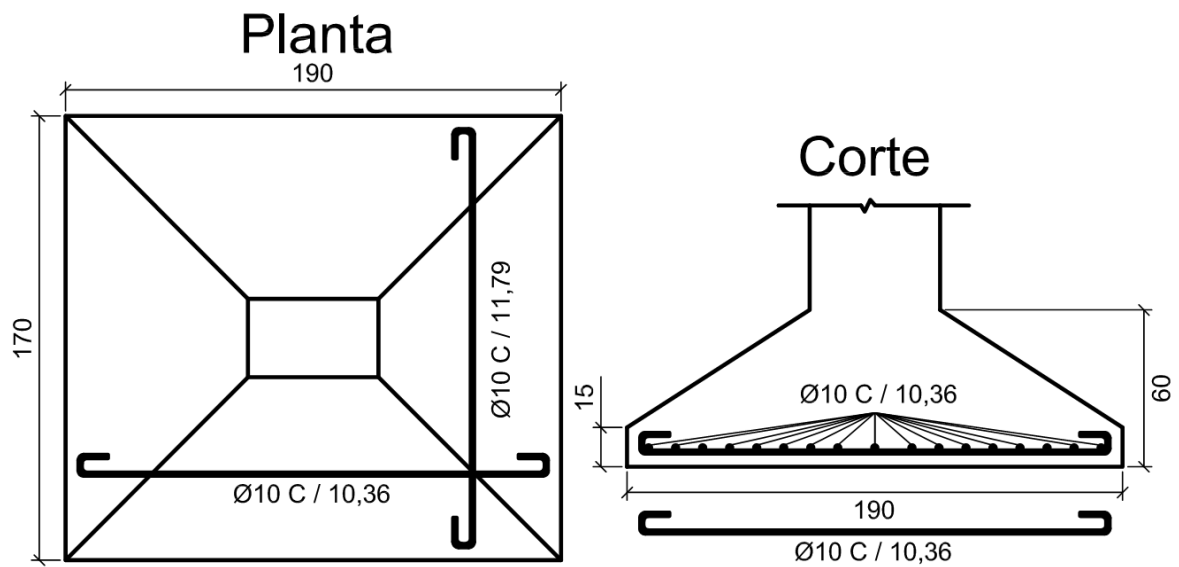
Detalhamento da sapata sobre viga alavanca.
